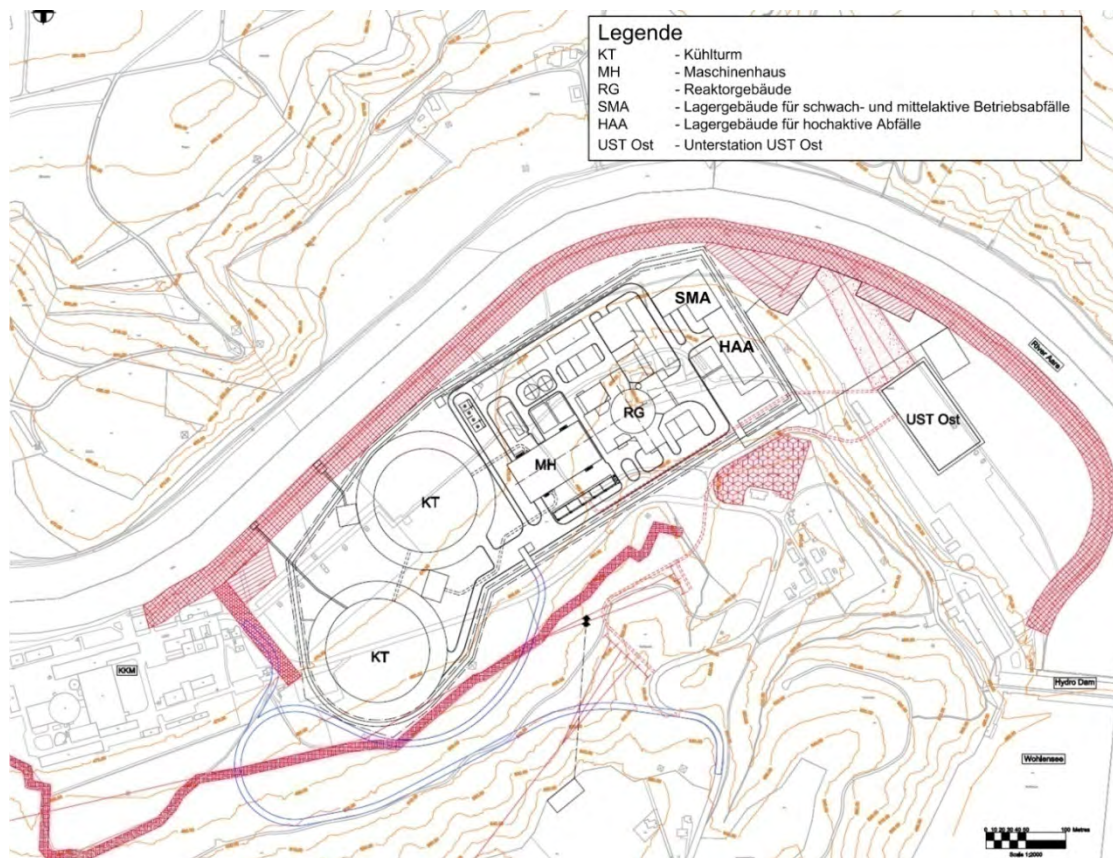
Exemple de plan de situation d'une installation nucléaire dotée d'un réacteur EPR et d'un refroidissement hybride avec deux tours de refroidissement hybride. Cette disposition correspond aux illustrations avec photomontage (Fig. 2.3-2, Fig. 2.3-3). Sous réserve de l'optimisation future du projet ainsi que du choix du système de réacteur et du fournisseur.
